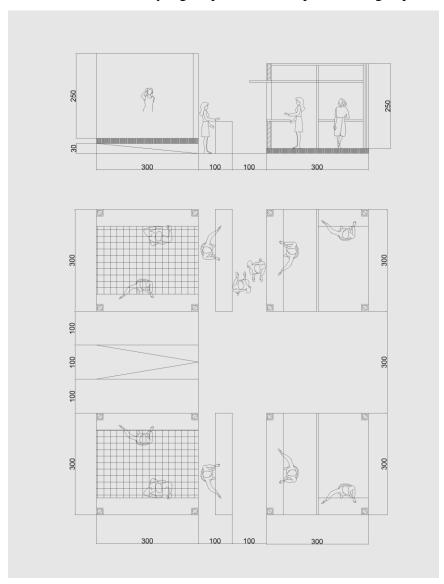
Potongan dan denah koridor yang diapit oleh kios tipikal di tengah pasar
